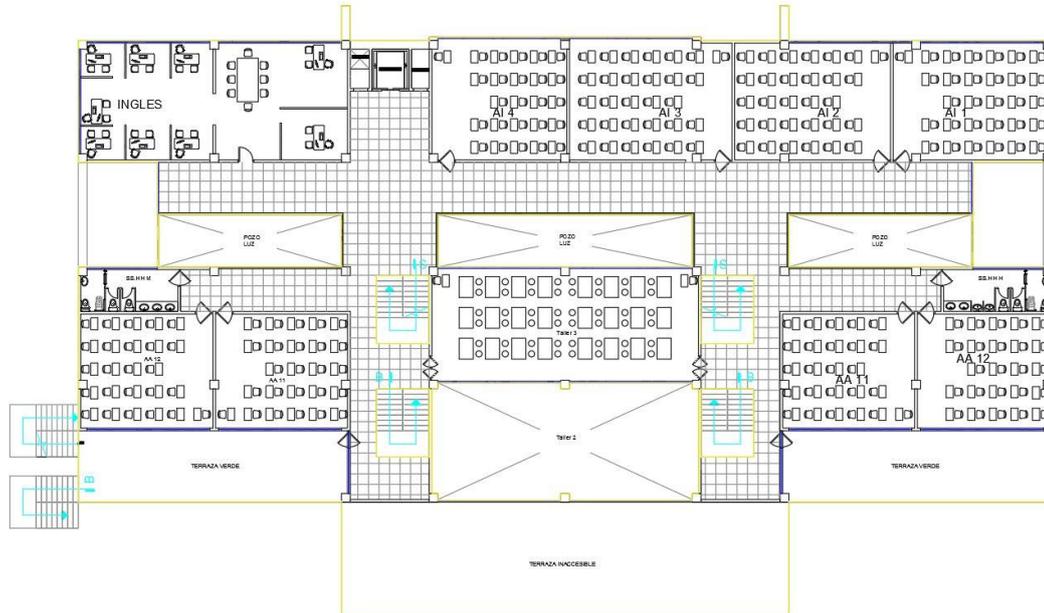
Planta alta arquitectónica nivel N+11.24 m
